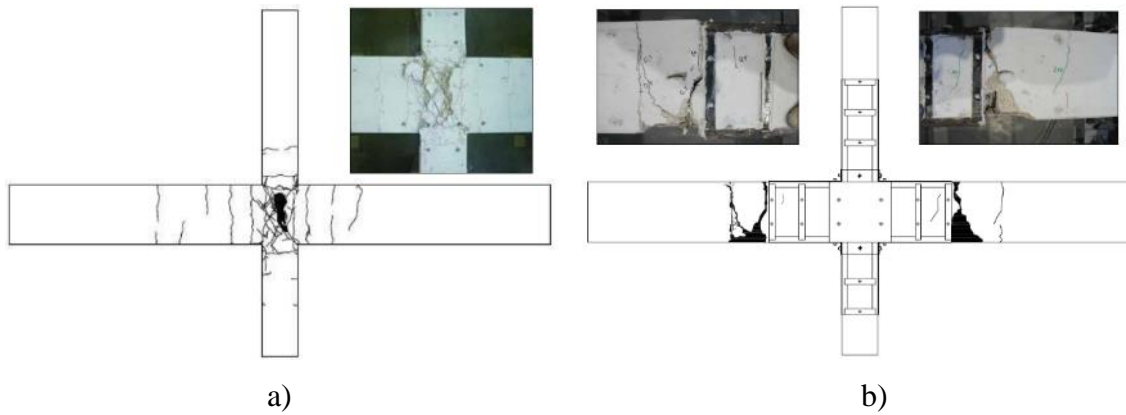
Estado final de dano nos provetes: a) provete IPA-1 original (Garcia,2011); b) provete IPA-1 reforçado
